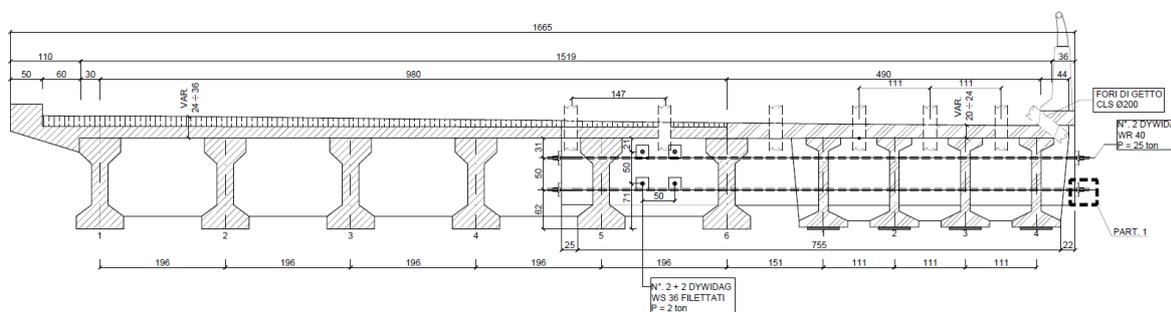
Sezione trasversale dei nuovi trasversi di collegamento (intervento 2019)
